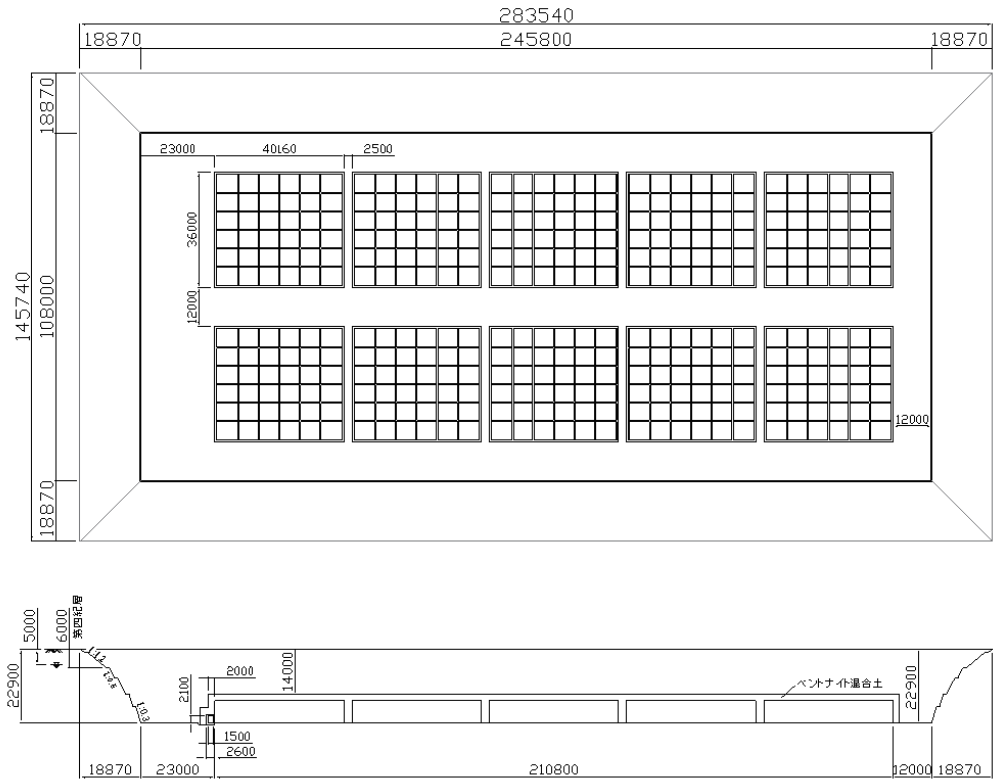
P 埋設地におけるコンクリートピット埋設施設の配置図
